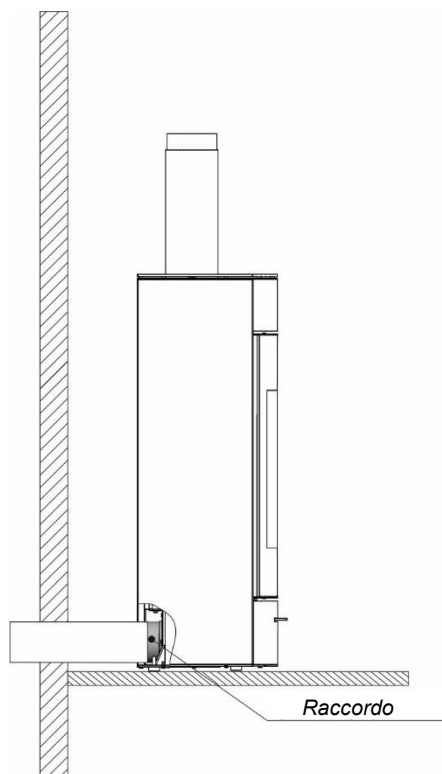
Connessione alla stufa AIR WOOD verso la presa d'aria esterna - versione dal retro dell'apparecchiatura.
